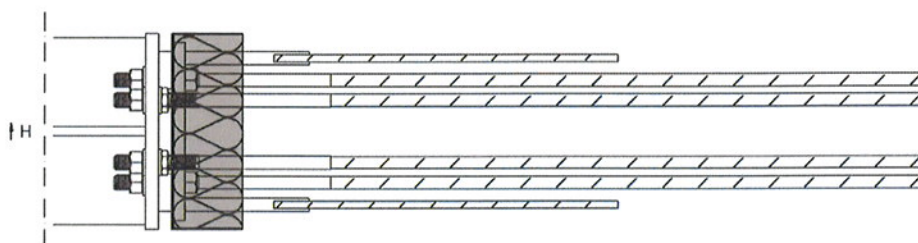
Grundriss Isopro Typ SBM14 QQ
